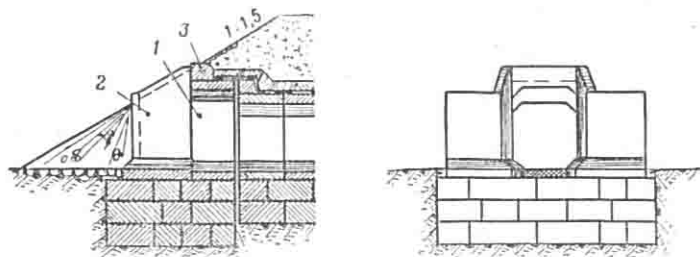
Прямоугольная блочная железобетонная труба отверстием 1,0—2,0 м с раструбным оголовком с повышенным звеном:
